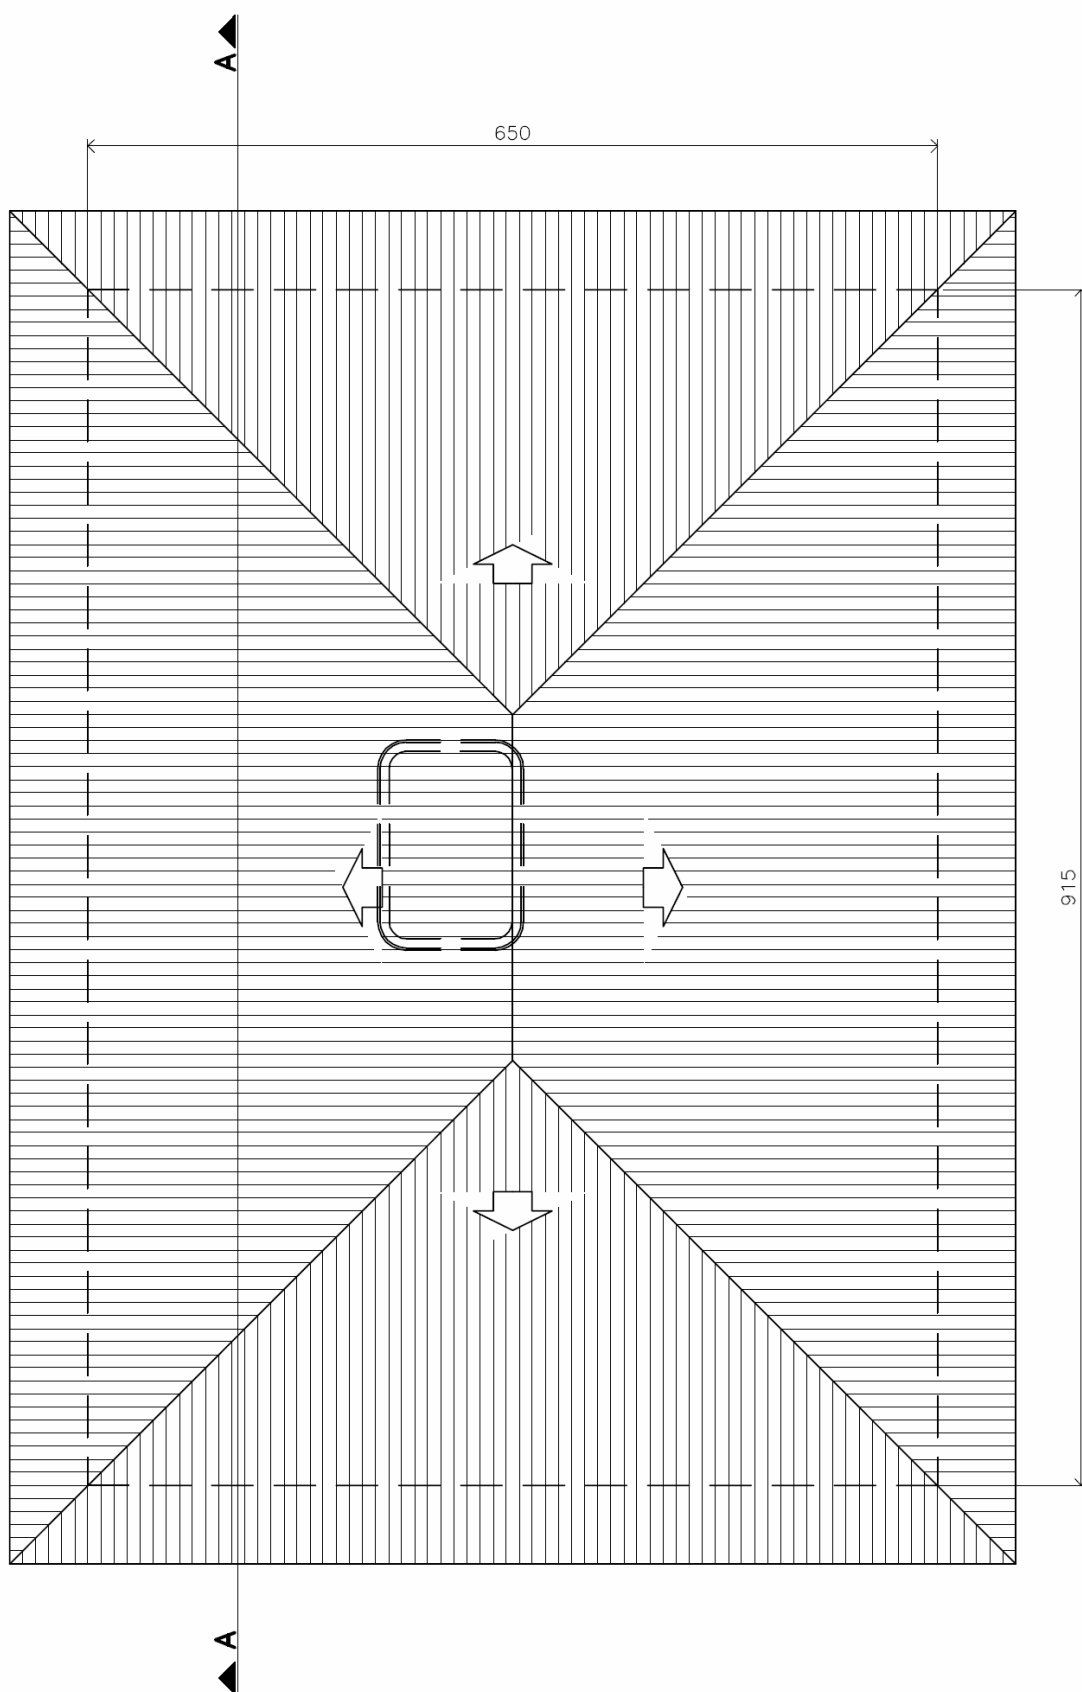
Arquitetura do Exemplo 1: Planta de cobertura
